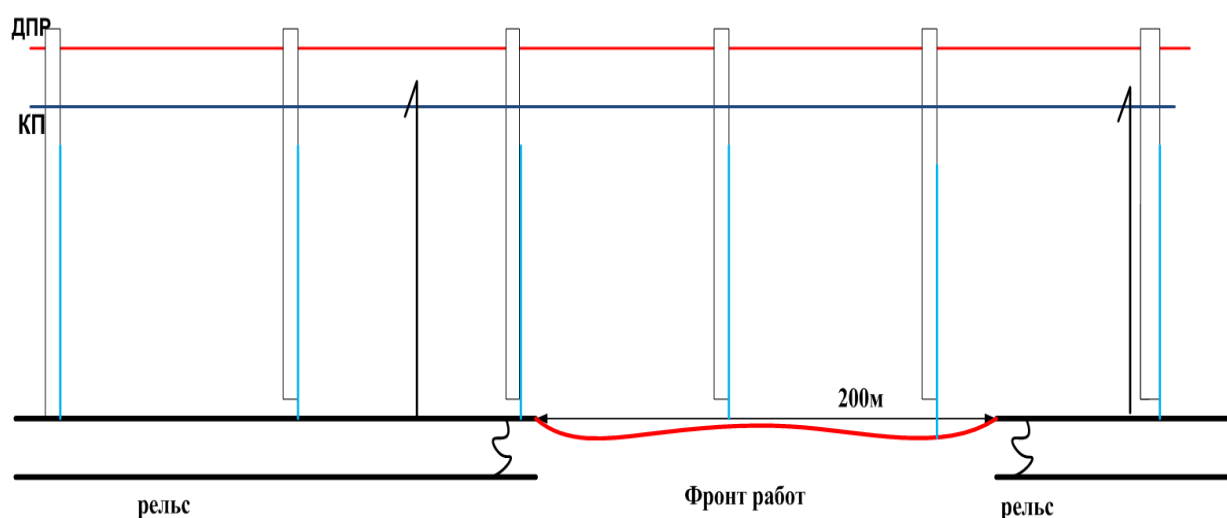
Схема шунтирования разрыва в рельсах продольной перемычкой
